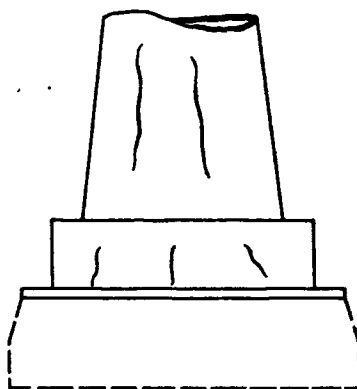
Agrietamiento en una chimenea. Si el revestimiento de ladrillo refractario hubiera estado separado del hormigón resistente mediante una capa de aire, las grietas no habrían aparecido. Citado por Bukowski¹.
